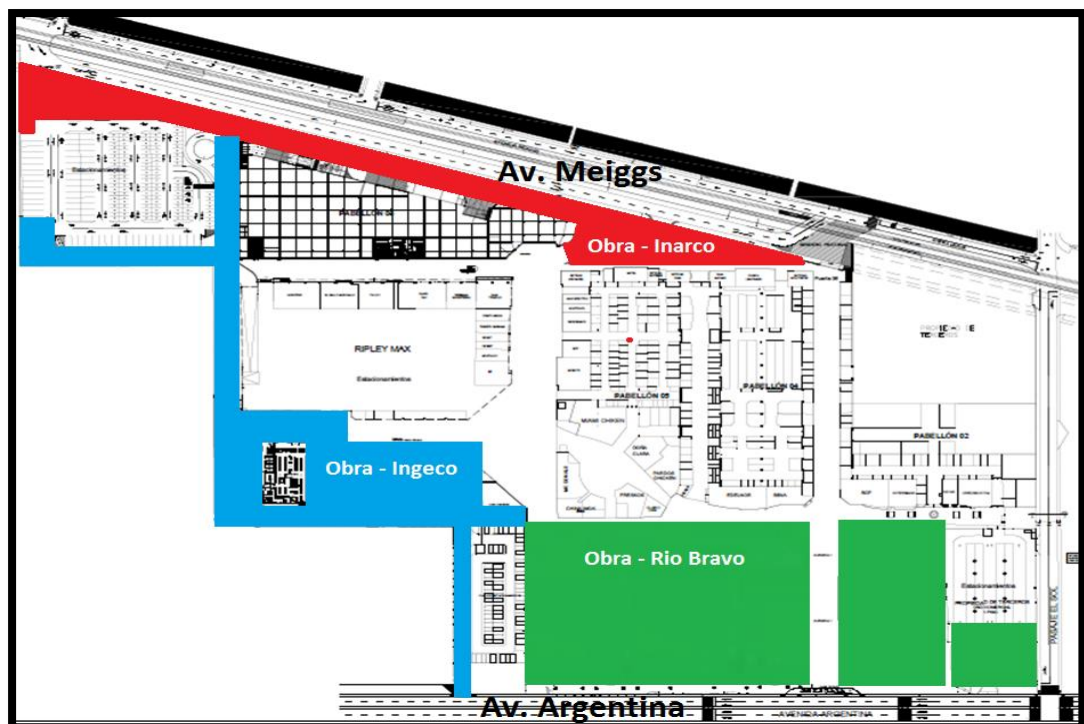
Plano de ubicación de la obra en Centro Comercial
